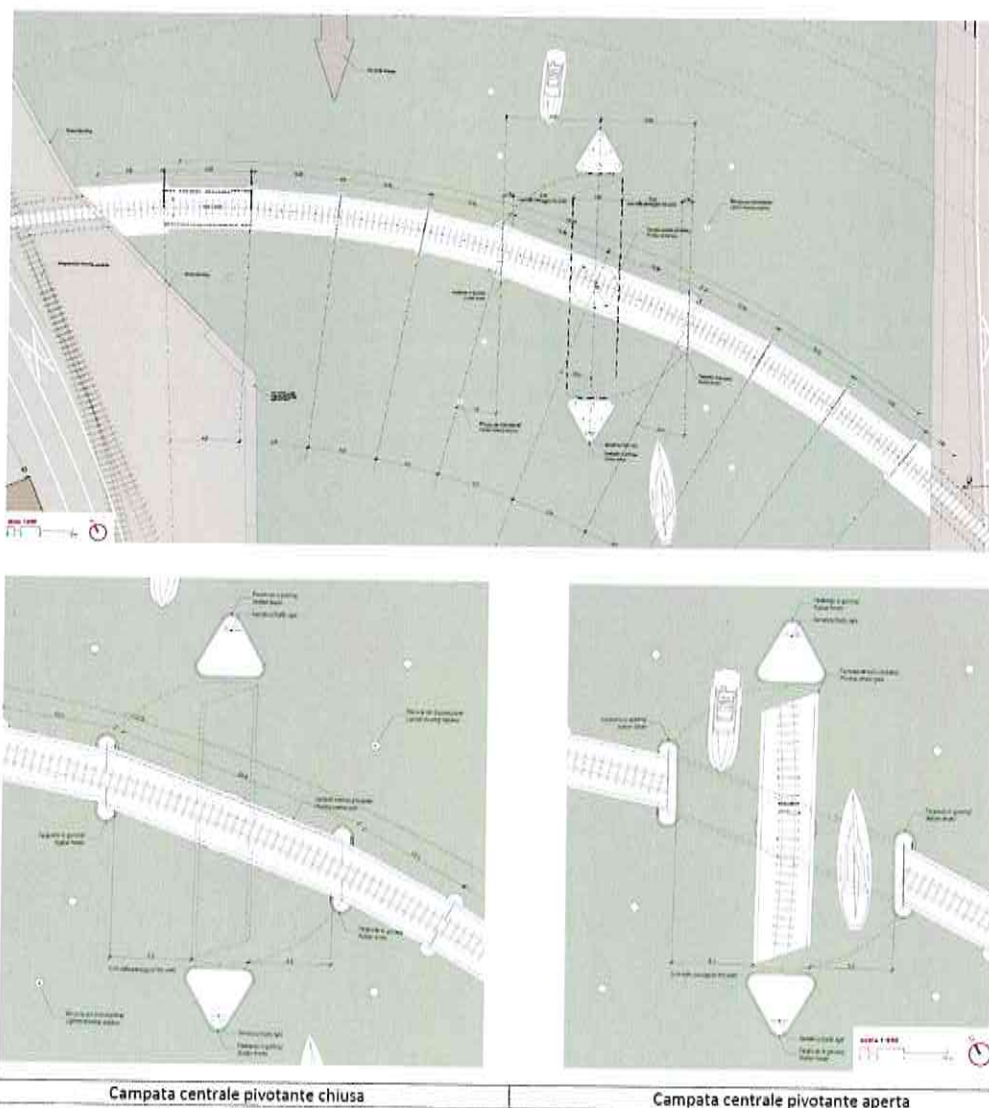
Planimetria del ponte a campata centrale pivotante e dettaglio di apertura/chiusura
